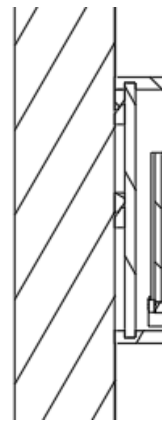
Pormenor do desenho técnico do sistema de escada. Fonte: Autora
